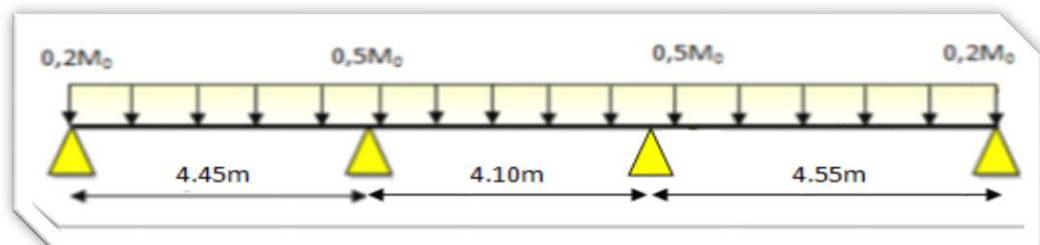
Schéma statique de plancher 10^{ème} étage (terrasse accessible).
